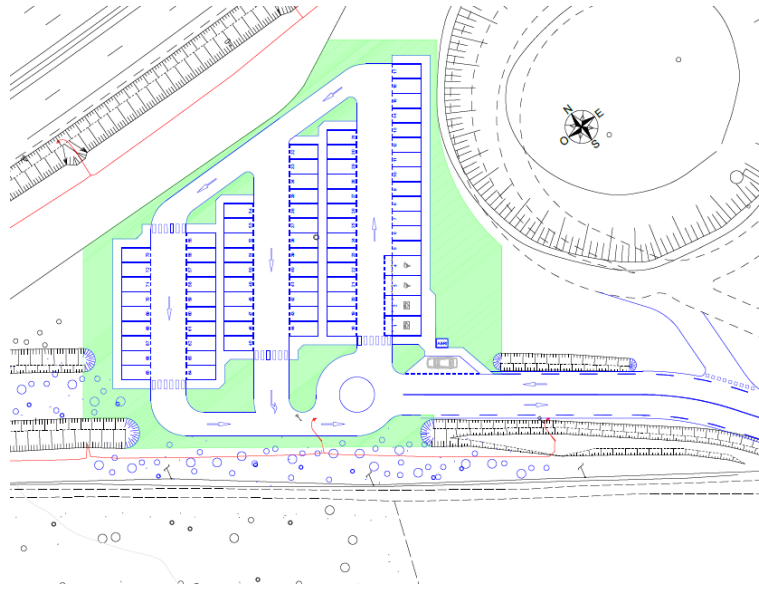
Exemple de plan pour un site sur la commune d'Olivet
